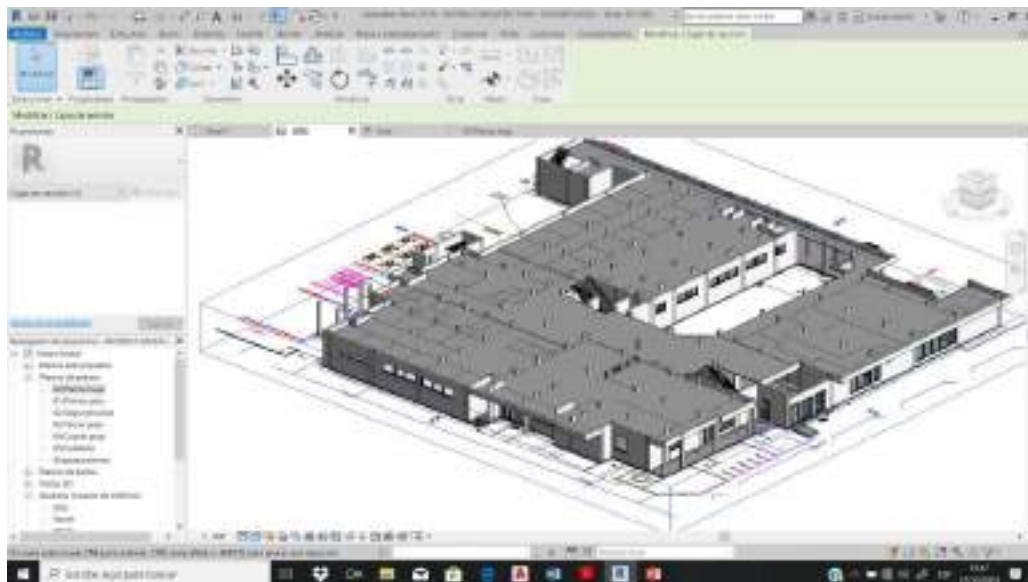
Autodesk Revit - Colocado y Visualización de techo (Planta Baja)
